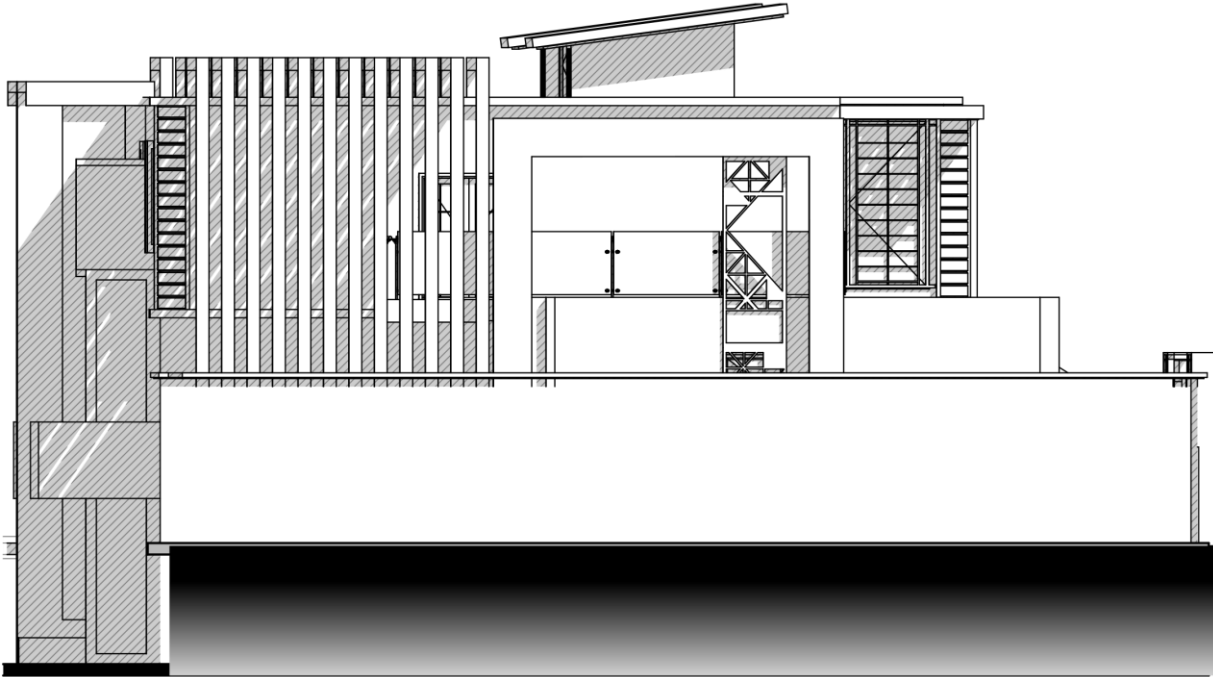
Façade latérale 1 avec clôture ech 1/100.
